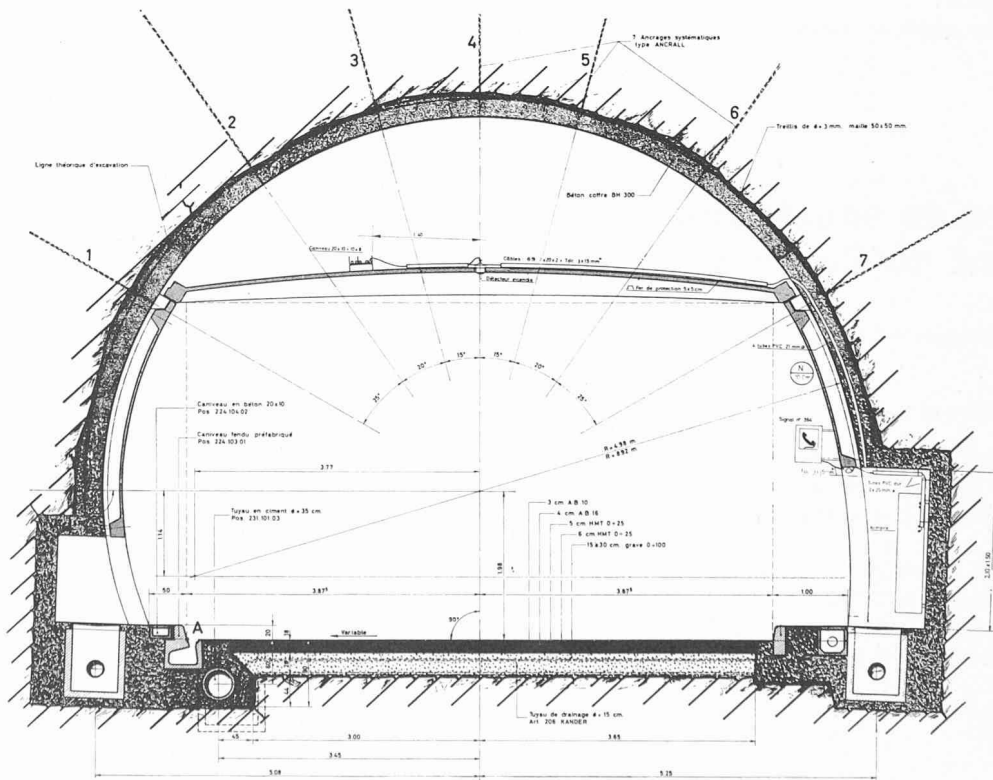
Coupe transversale au droit d'une niche de secours.
